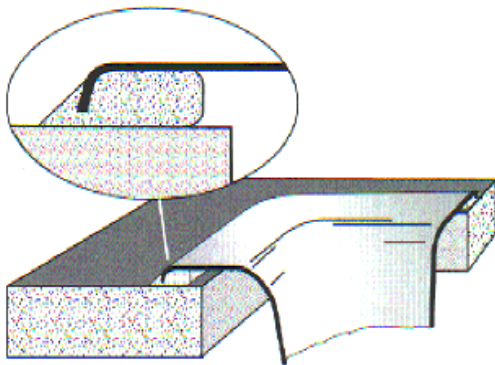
Abdichtung mit untergelegtem Dichtungsprofil
